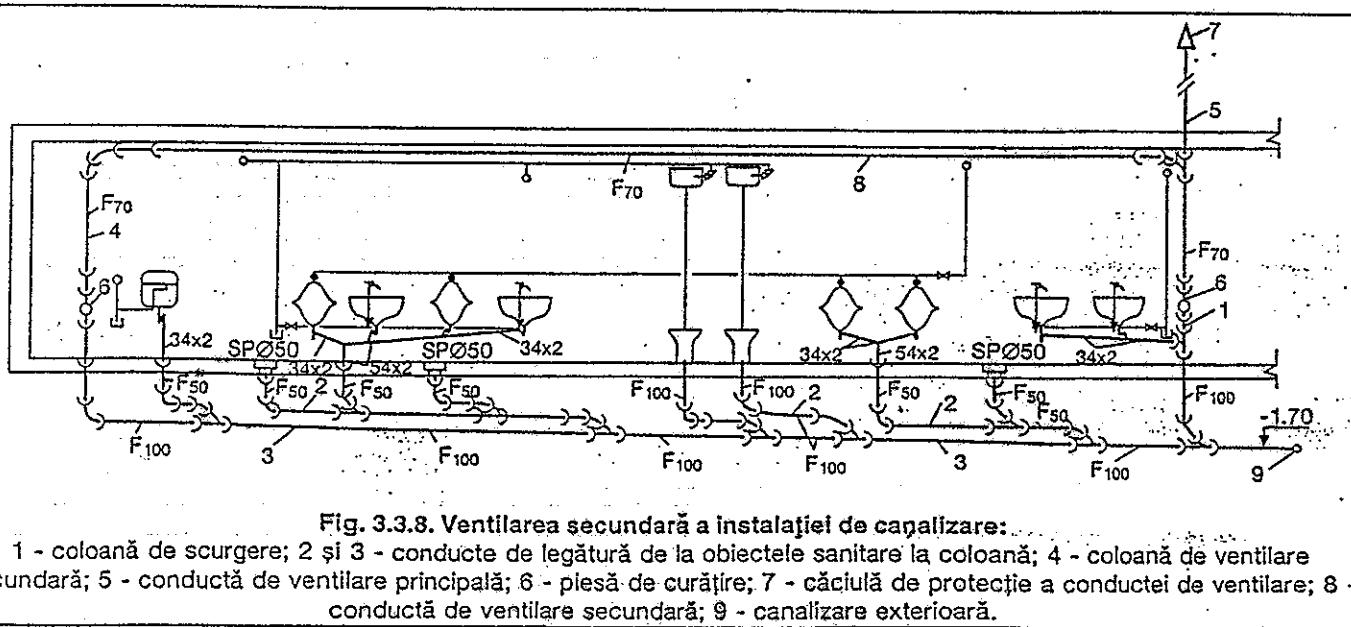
Ventilarea secundară a instalației de canalizare:
